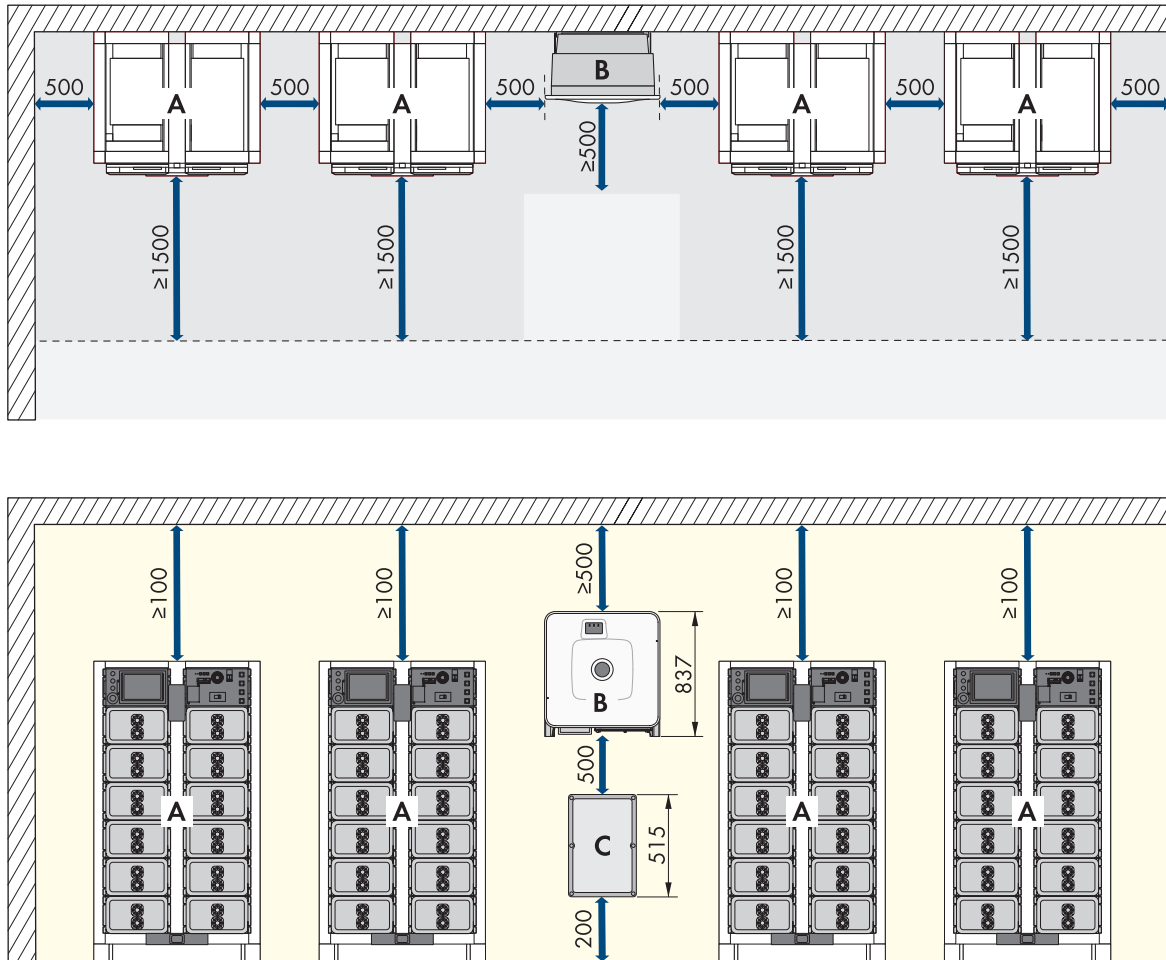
Exemple d'implantation d'un système avec 4 armoires de batteries (dimensions en mm)
